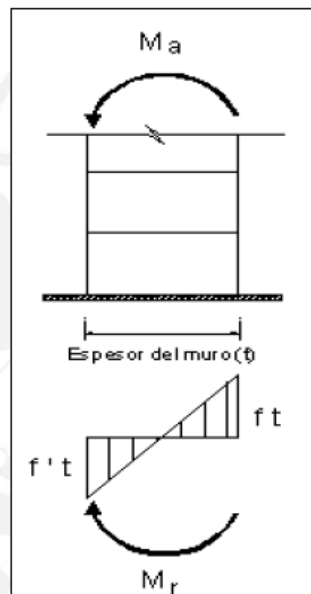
Momento resistente (M_r) en un muro de albañilería (Fuente: Laucata, 2013)
